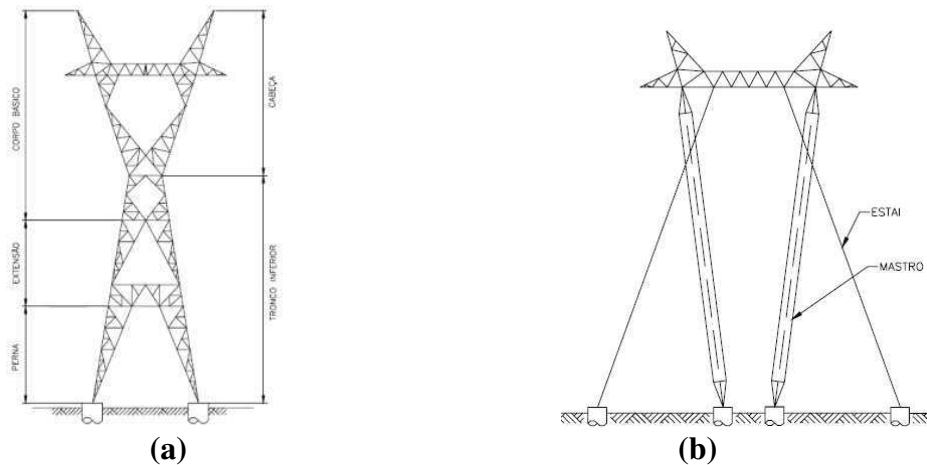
Silhuetas de estrutura (a) metálica autoportante; (b) metálica estaiada.
